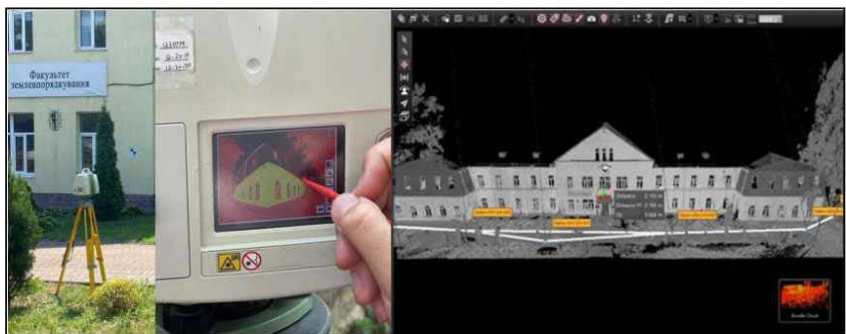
Лазерне сканування фасаду будівлі навчального корпусу № 6
